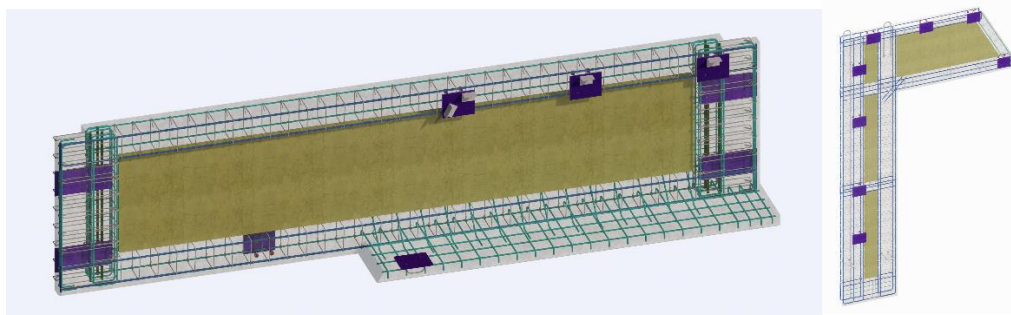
Detalles LOD 400. / Ilustración: Empresa 1.
